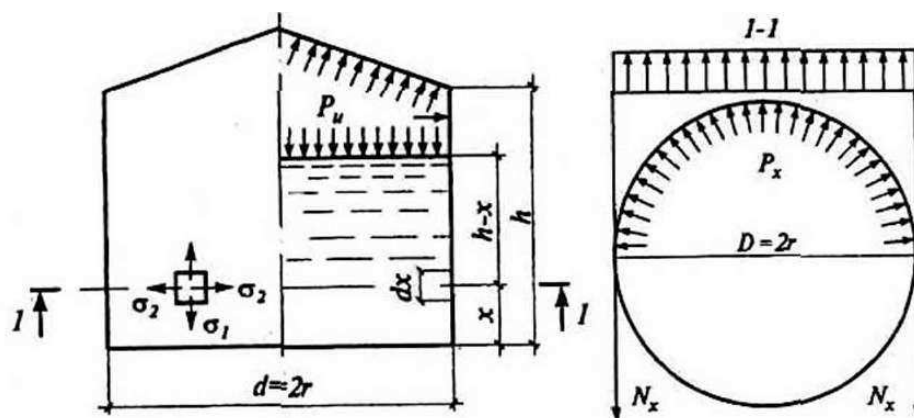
Розрахункова схема вертикального циліндричного резервуара
